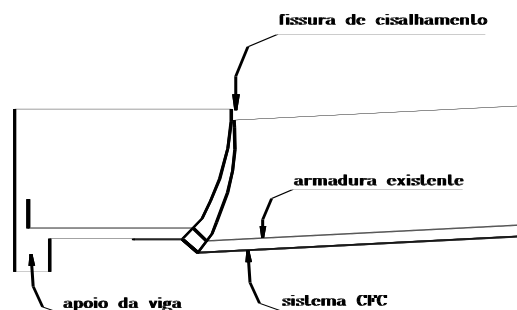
Delaminação devida a fissuras de cisalhamento na viga.
